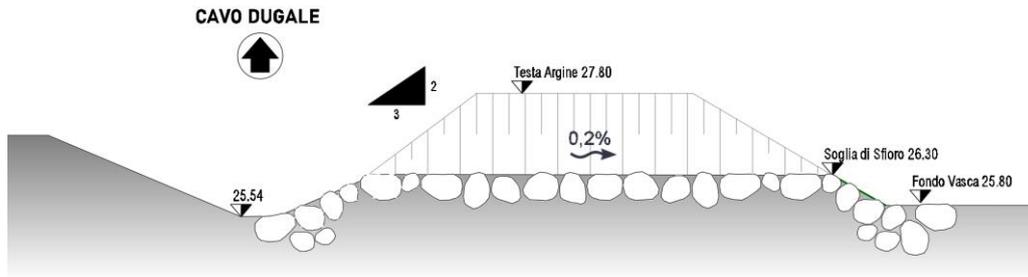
Manufatto di ingresso al bacino di laminazione: sezione trasversale – Cavo Dugale
